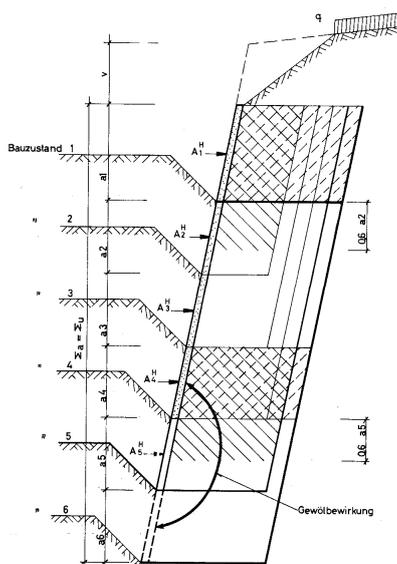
Aushubetappen mit entsprechender Tragwirkung [5]
